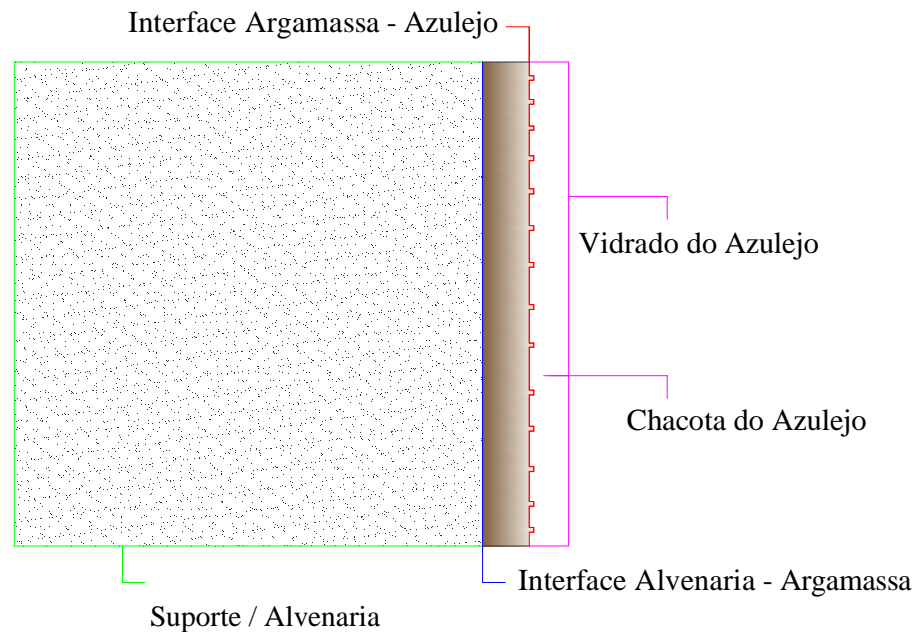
Ilustração de fachada típica em azulejos e respetiva constituição.
